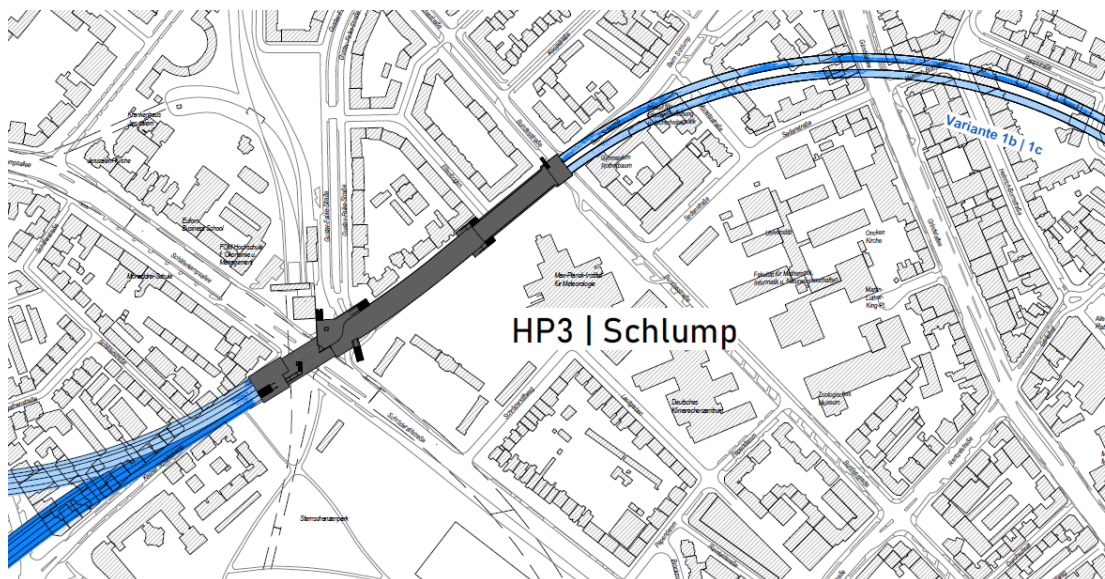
Lageplan Stationsbauwerk HP 3 Schlump, Variante 1 (blau/hellblau), Station I (Variantenstudie).
